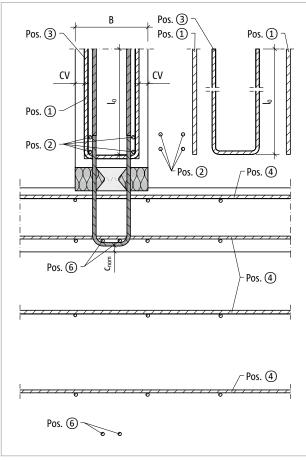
Schöck Sconnex® type W-NT-B : renforcement sur site dans le cas d'un ancrage de l'effort de traction dans la dalle
